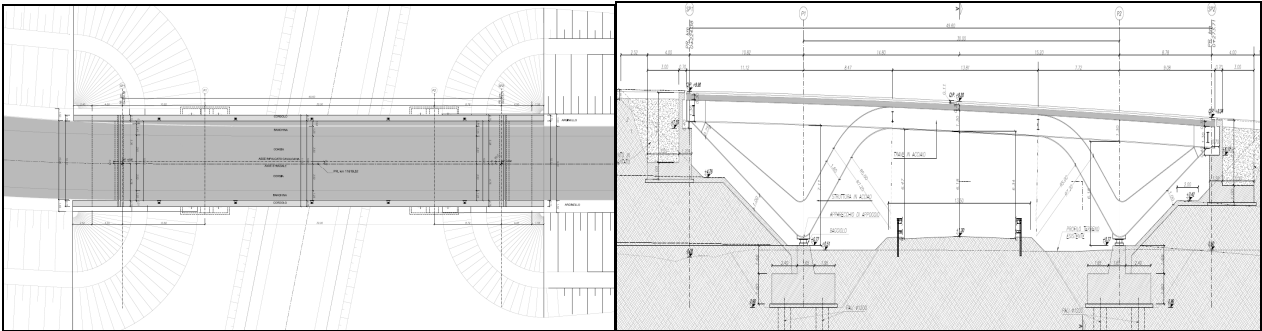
Pianta e Sezione longitudinale Cavalcavia svincolo S. Biagio
